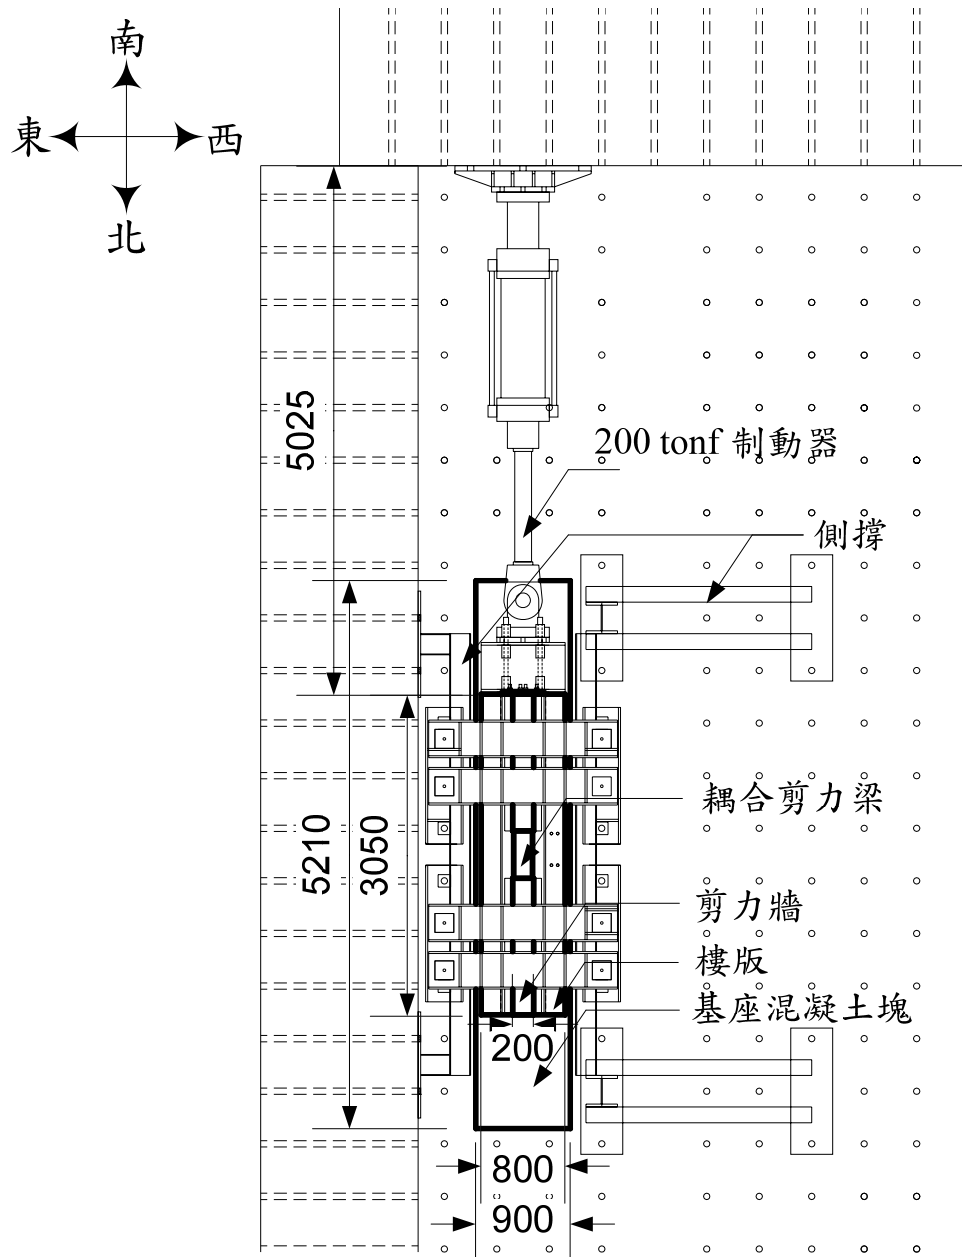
(a) 實驗配置平面圖 (單位：mm)
